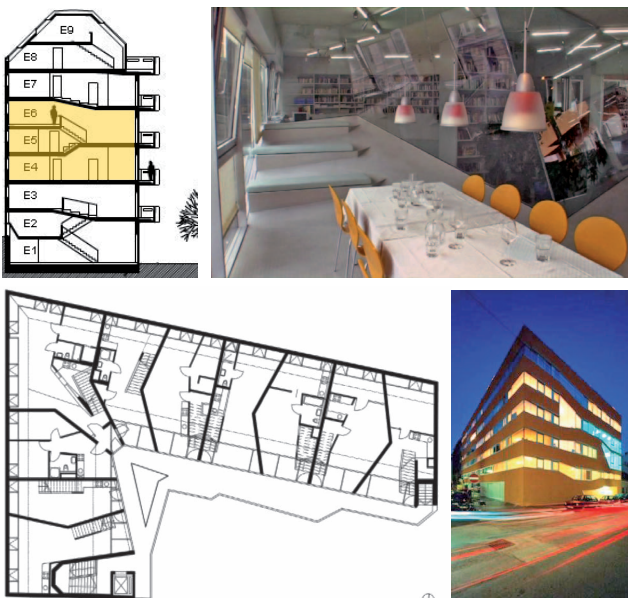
| Schnitt, Grundriss und Eindrucksbilder der Miss Sargfabrik
